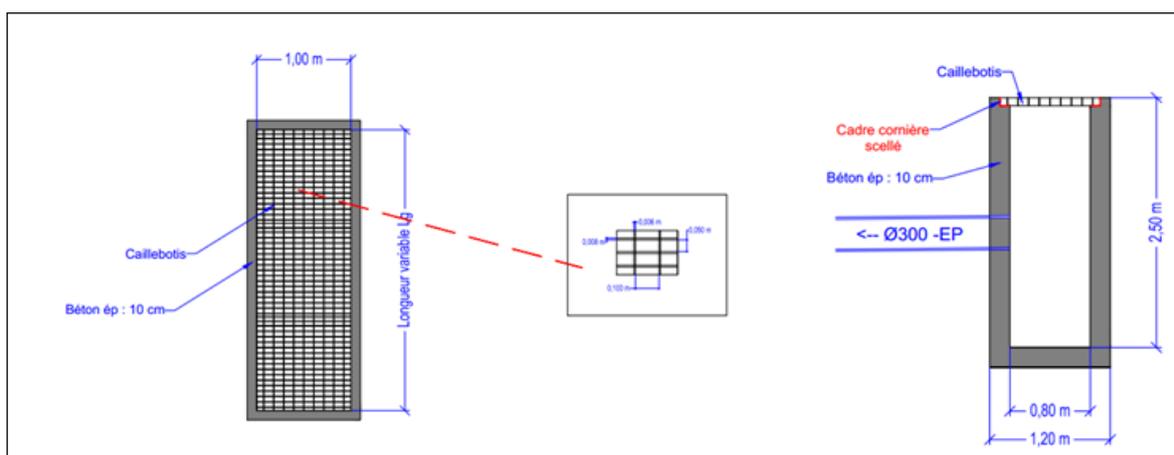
Extrait du plan de masse - Coupes types d'un dépierreur
